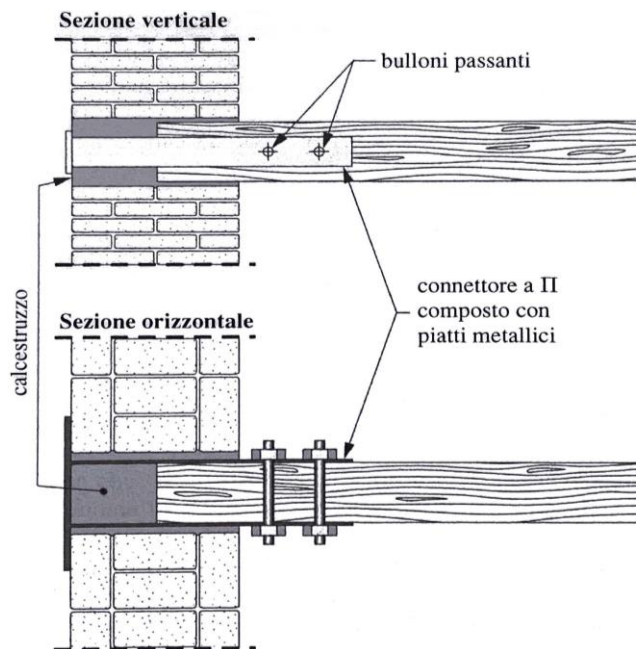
Esempio di elementi in acciaio per il rinforzo del collegamento dei solai alla muratura [4]
